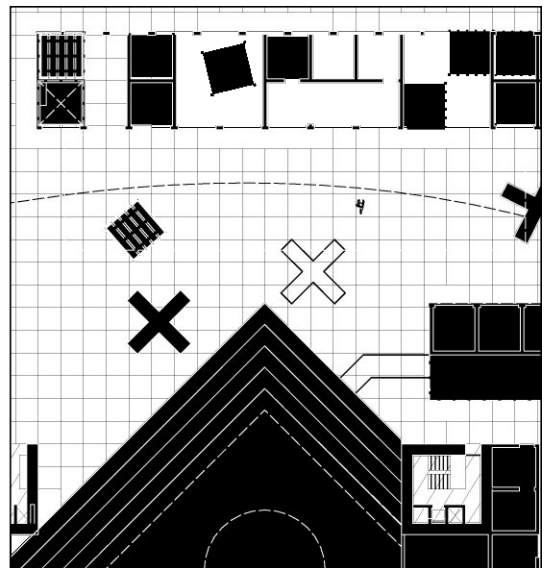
Grundriss Ausschnitt Via dei Lucani; öffentliches Erdgeschoss
